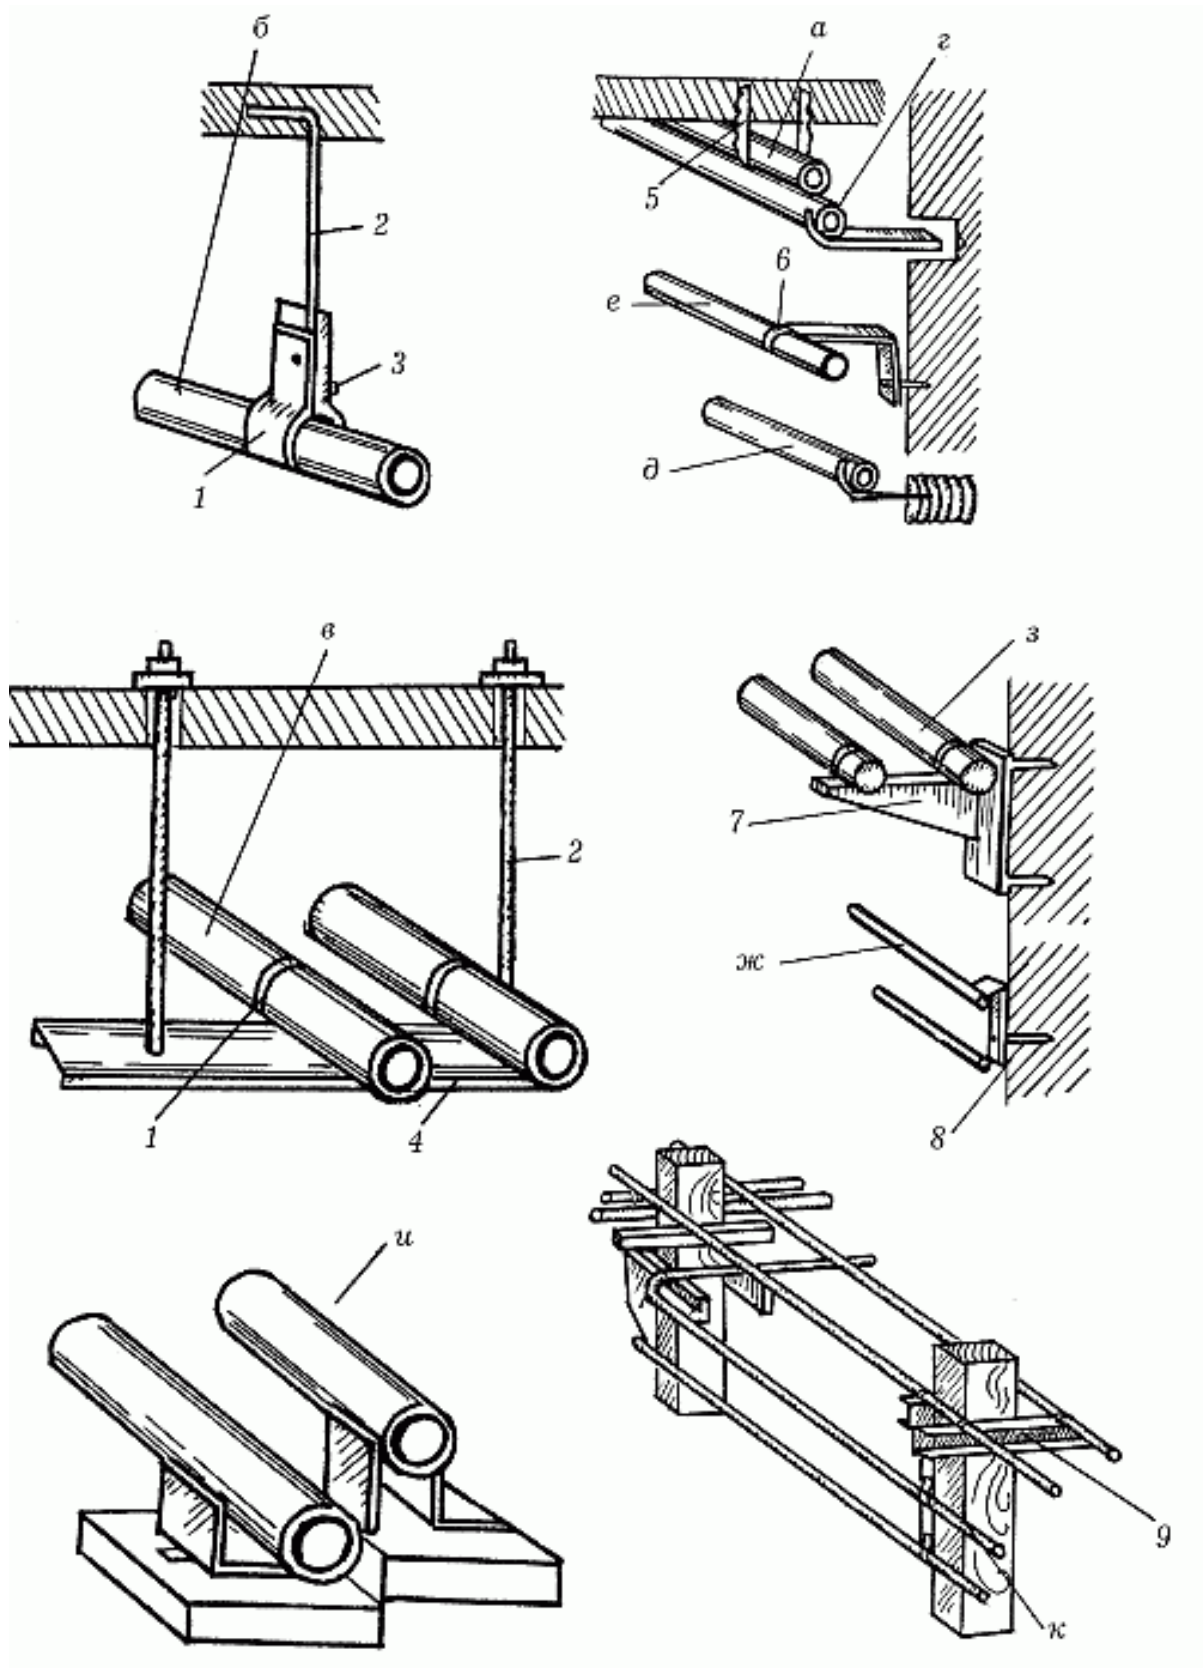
Виды неподвижного крепления труб: а – скобой; б – на подвеске; в – на подвеске с опорной балкой; г – на кронштейне; д – крючком; е – на кронштейне и хомуте; ж – сваркой к кронштейну; з – на кронштейне с подкосом; и – к уголкам; к – к опорным столбам или колоннам; 1, 6 – хомут; 2 – тяга; 3 – болт; 4 – балка; 5 – скоба; 7 – подкос; 8 – дюбель; 9 – швеллер
